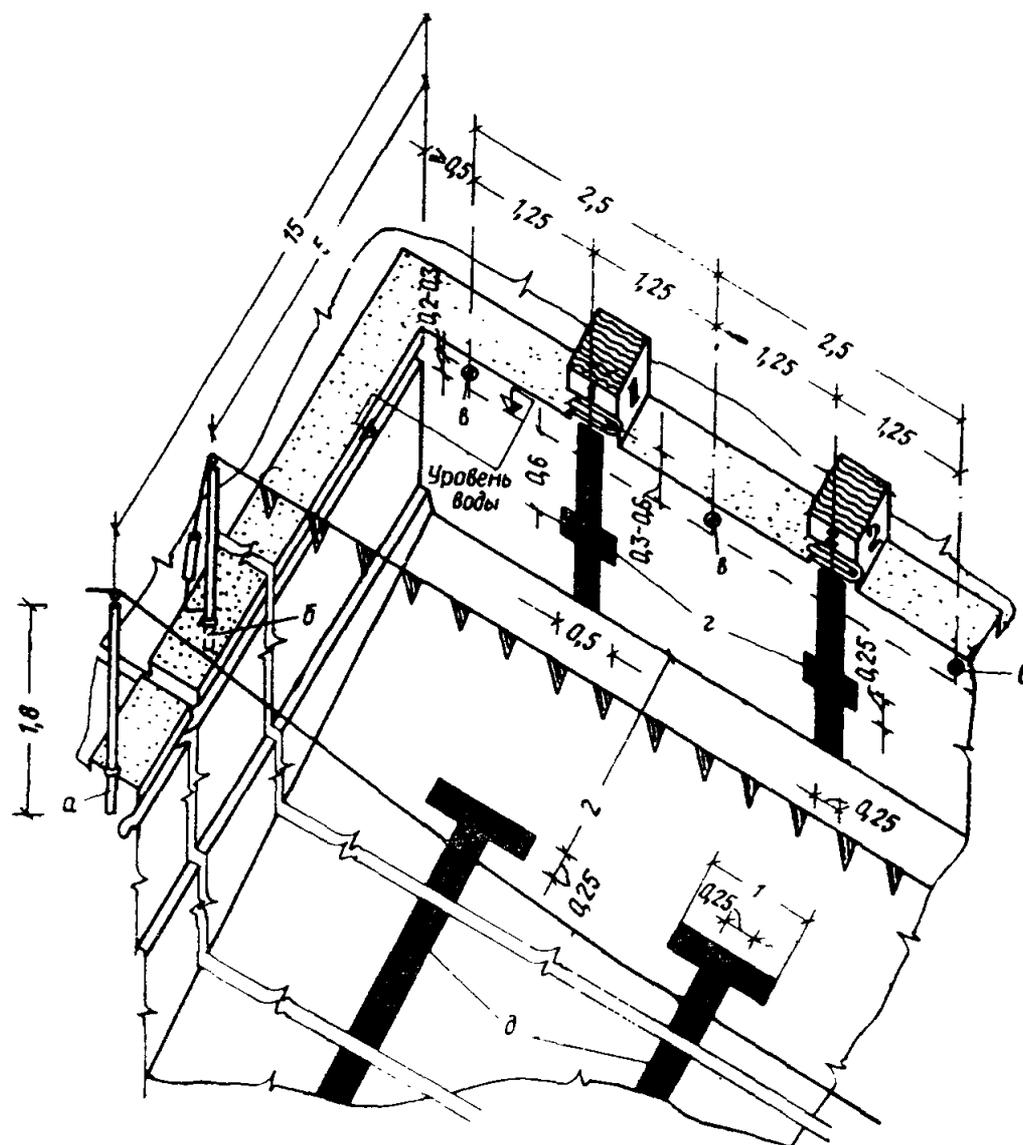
Размещение закладных устройств и разметка ванны для спортивного плавания (размеры в м)
